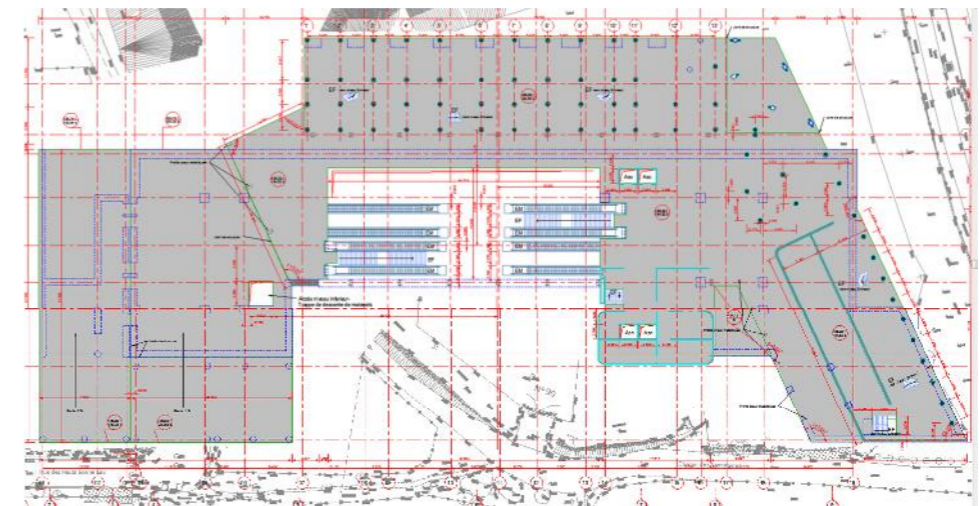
Bâtiment voyageurs avec projet connexe – Vue en plan – Niveau rez-de-chaussée
